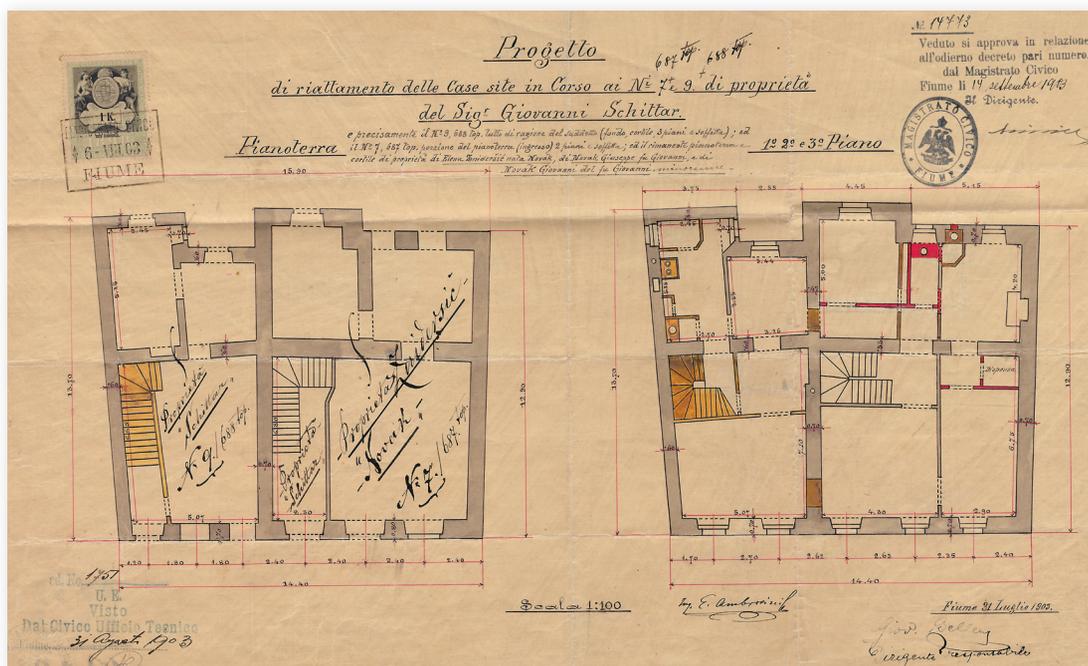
Emilio Ambrosini: Haus Schittar, Grundrisse Bestandsplan, 1903.
